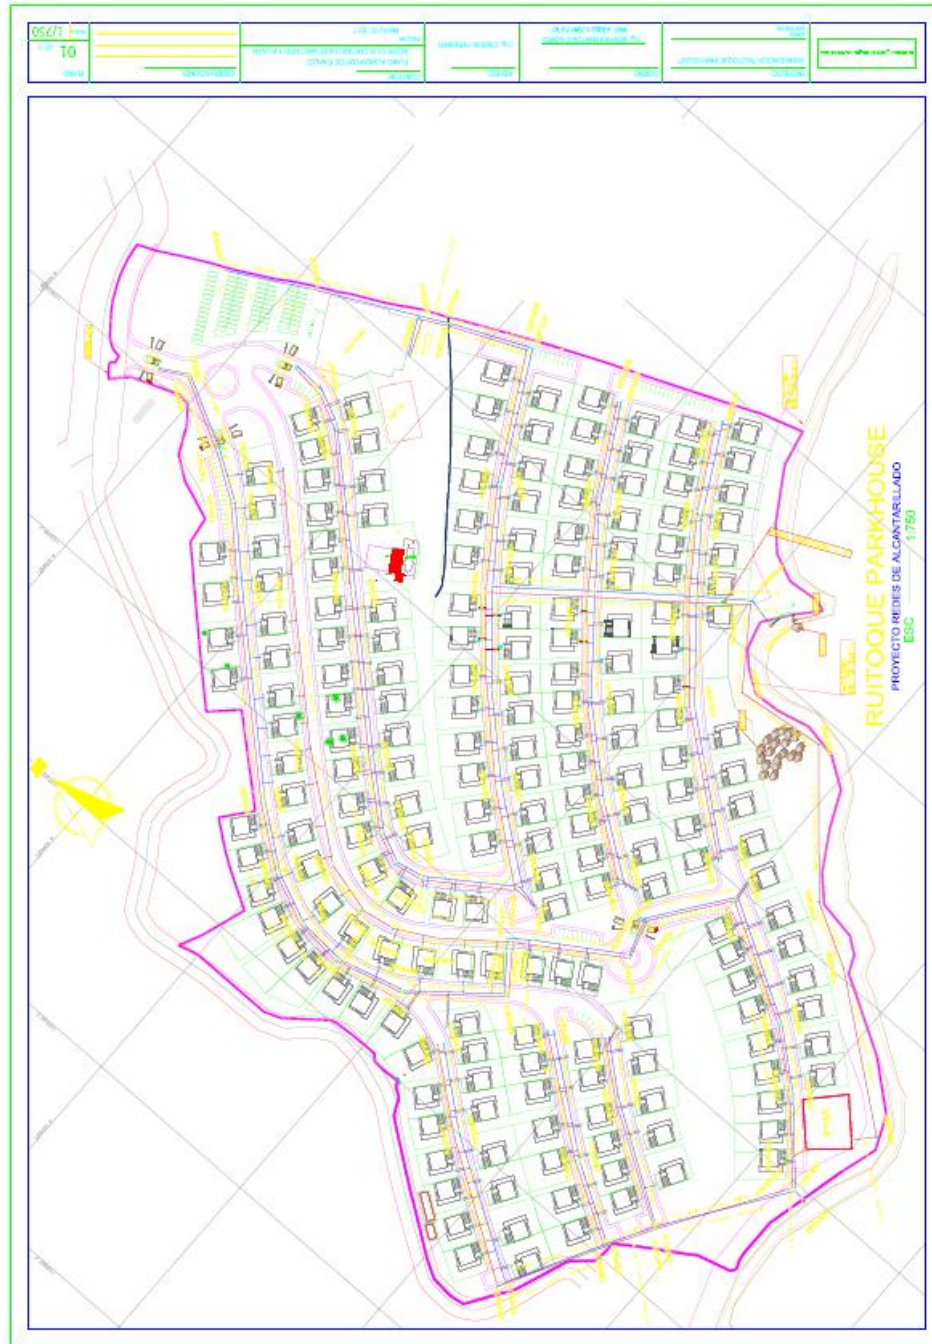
Plano diseño de Acueducto – RUITOQUE PARK HOUSE
